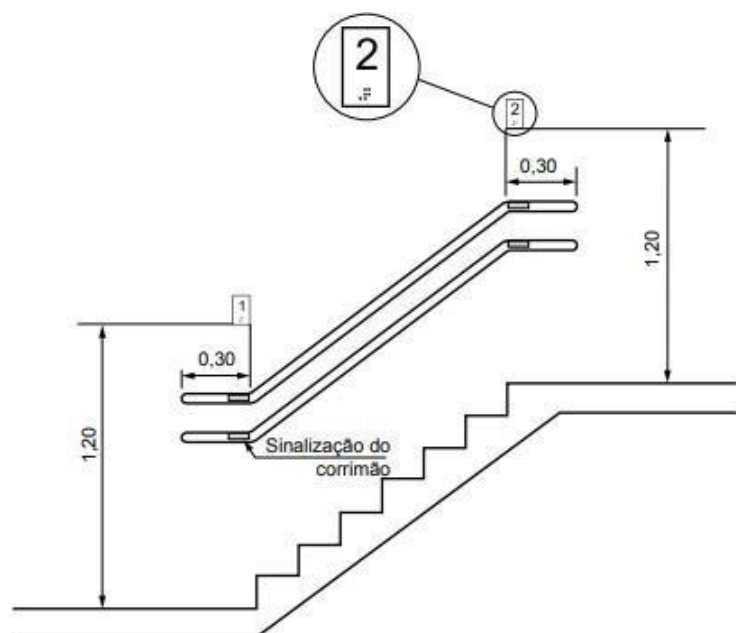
Sinalização de pavimento em vista lateral – dimensões em metros.
